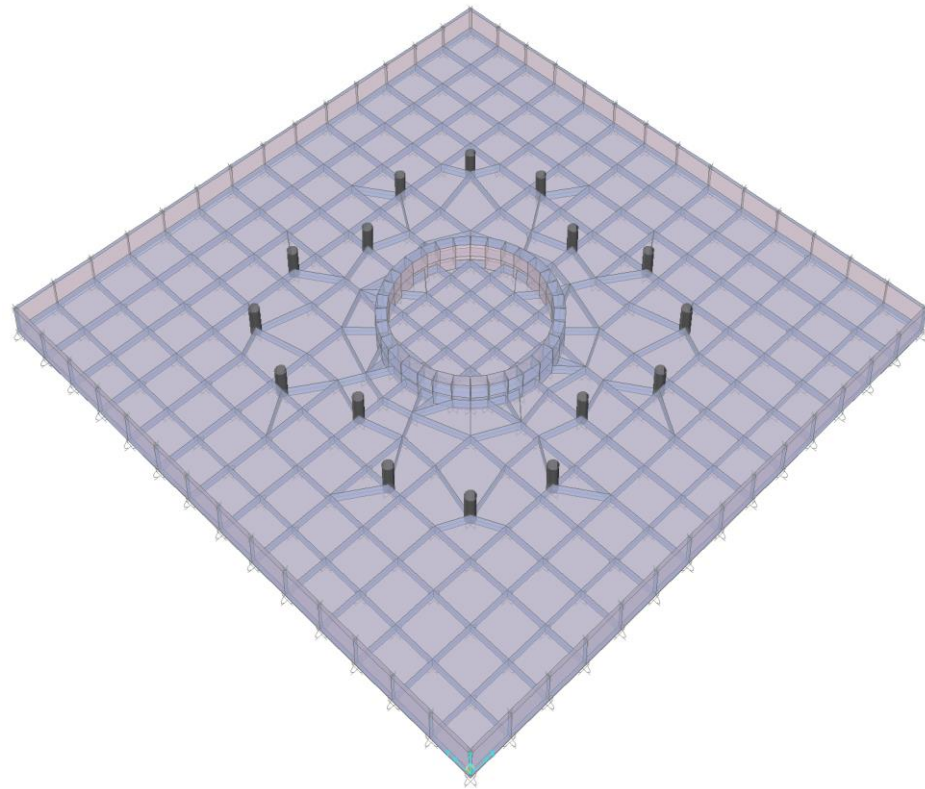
Detalle de la planta sótano, aquí se puede ver el arranque del muro del núcleo central, los soportes metálicos del edificio, el muro del sótano y la losa de cimentación.
